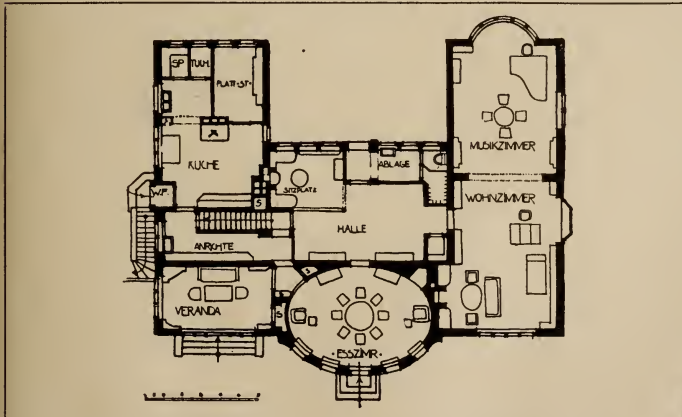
Haus mit einer Halle ohne Treppeneinbau
